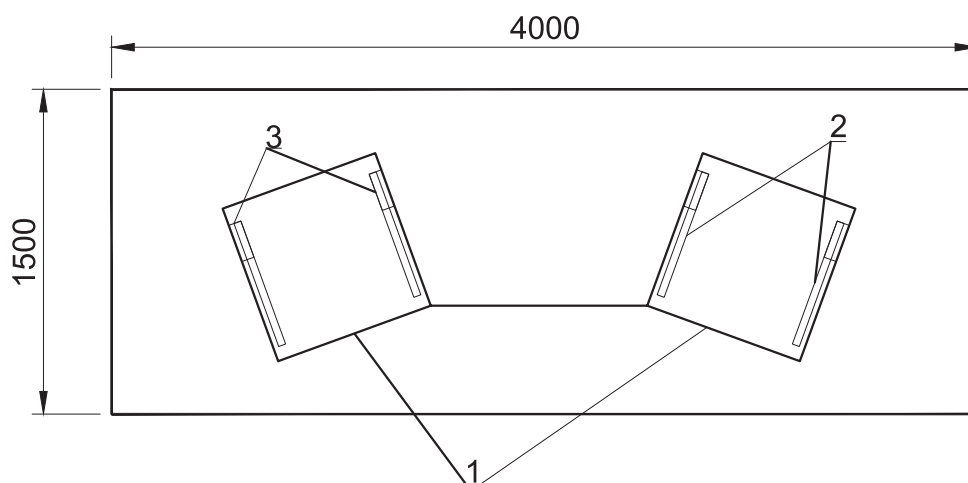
Фехтовальная дорожка с рамой крепления кресел-колясок. Обозначения: 1 — фиксируемая платформа; 2 — рама; 3 — крепление кресел-колясок
